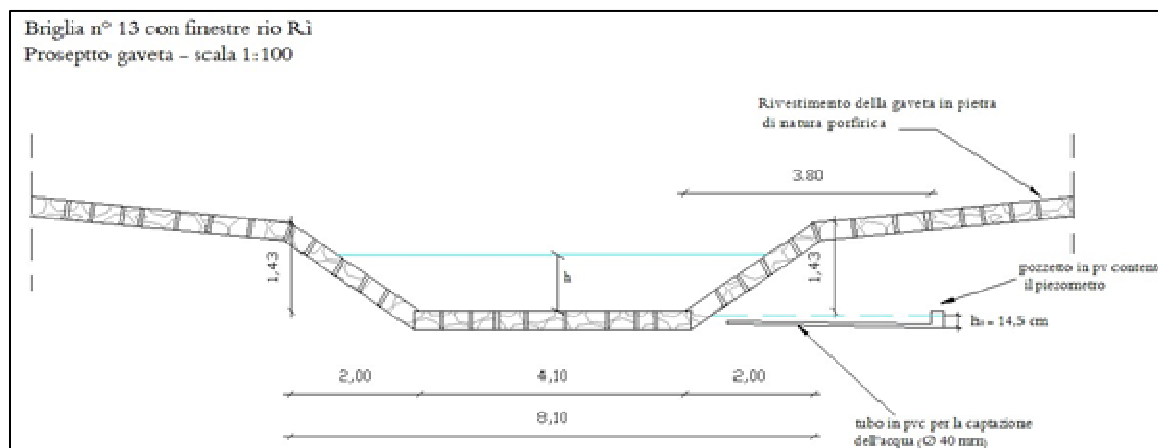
Prospetto gaveta briglia n°13 sul rio Rì.
